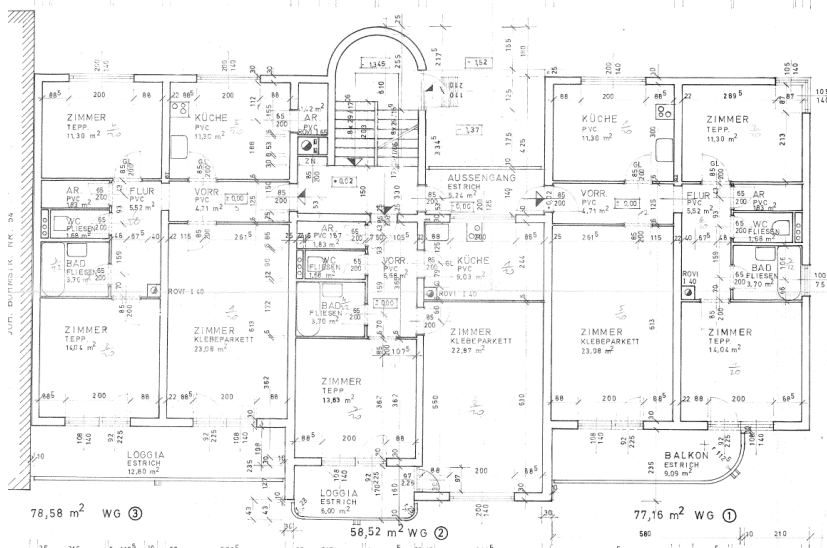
Plan: Grundriss Erdgeschoss; Stand 09.12.1976
